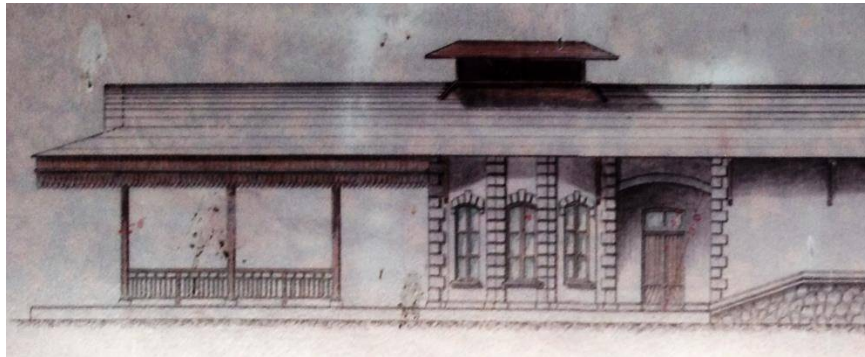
Fachada principal estación San Vicente, donde se muestra la chimenea sobre la cubierta de techo. Fuente: Visita de campo
